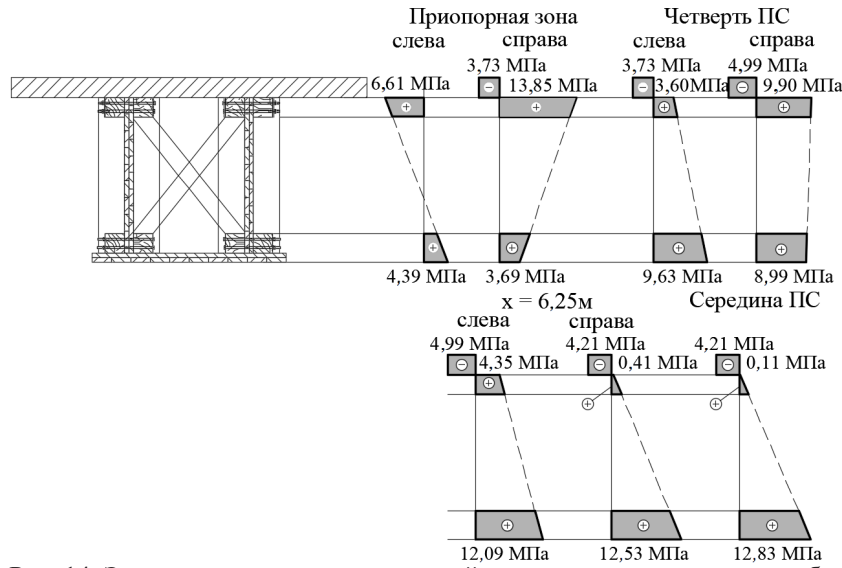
Эпюры нормальных напряжений в характерных сечениях комбинированного пролетного строения с дощато-гвоздевыми блоками и железобетонной плитой проезжей части (ПС – пролетное строение)
